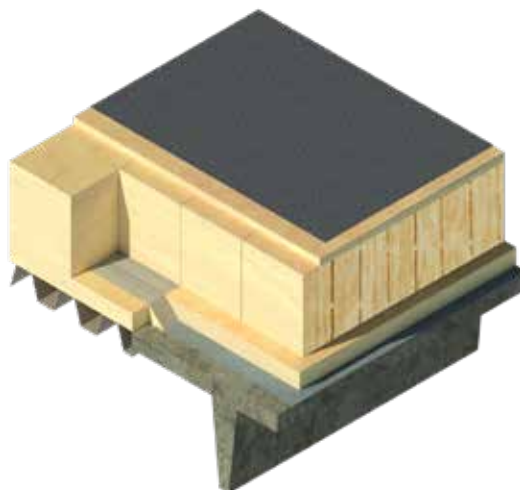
Övergång mellan trapetsprofilerad stålplåt och underlag av betong.
